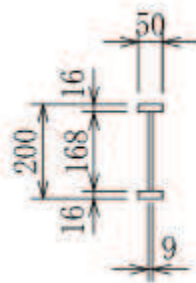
補助縦桁の断面形状 (単位 : mm)
